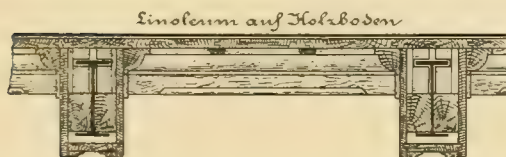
Eisenträger-Holzbalkendecke für Linoleumbelag.
